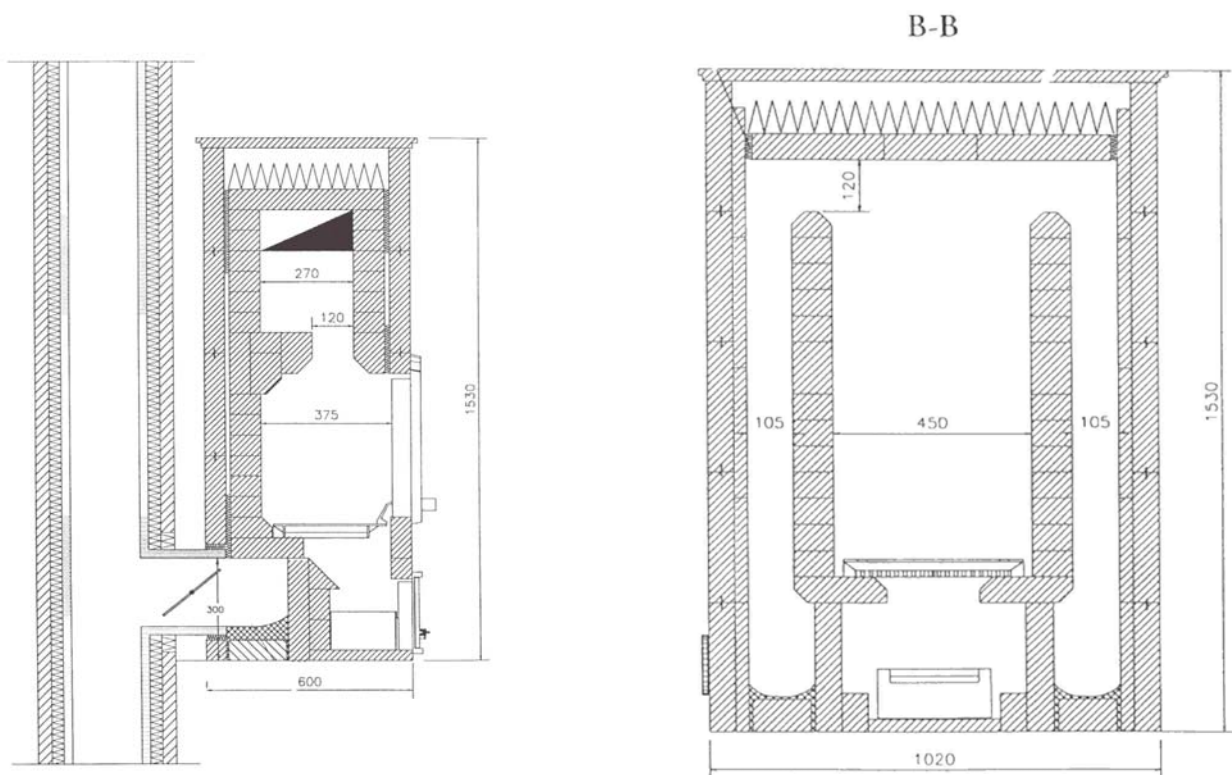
Coupe d'un poêle - cheminée TULIKIVI (modèle TU 2200)
